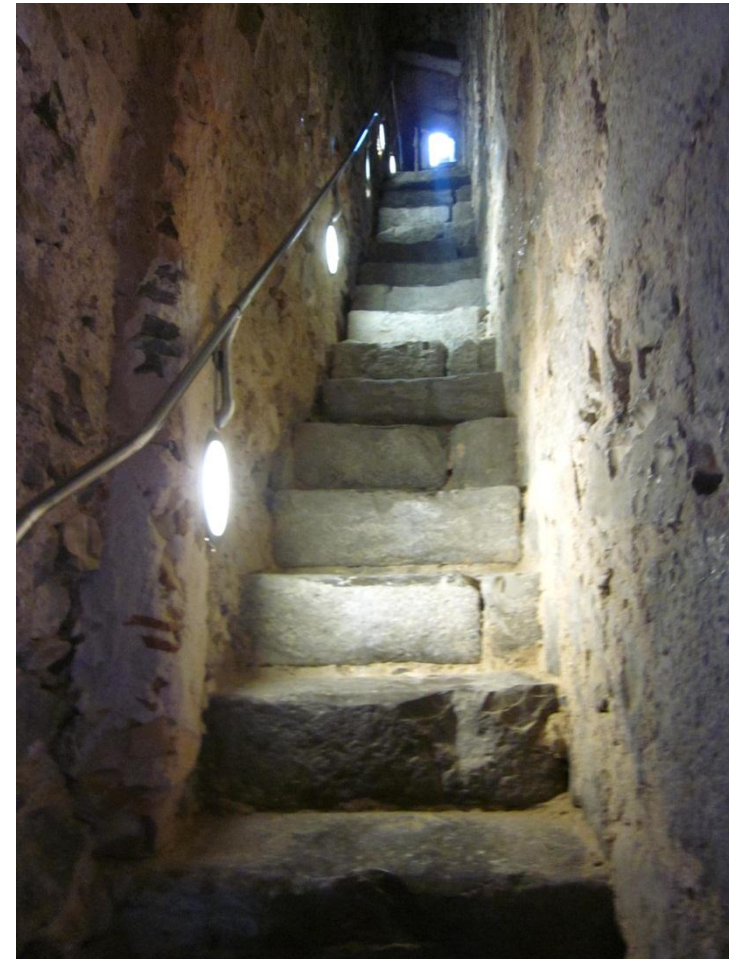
Escalera interna que une la planta baja con la primera planta, y con la terraza de la parte superior. Esta se encuentra en el interior de la fachada noroeste, que es por donde se accede a la Torre del Rei.
